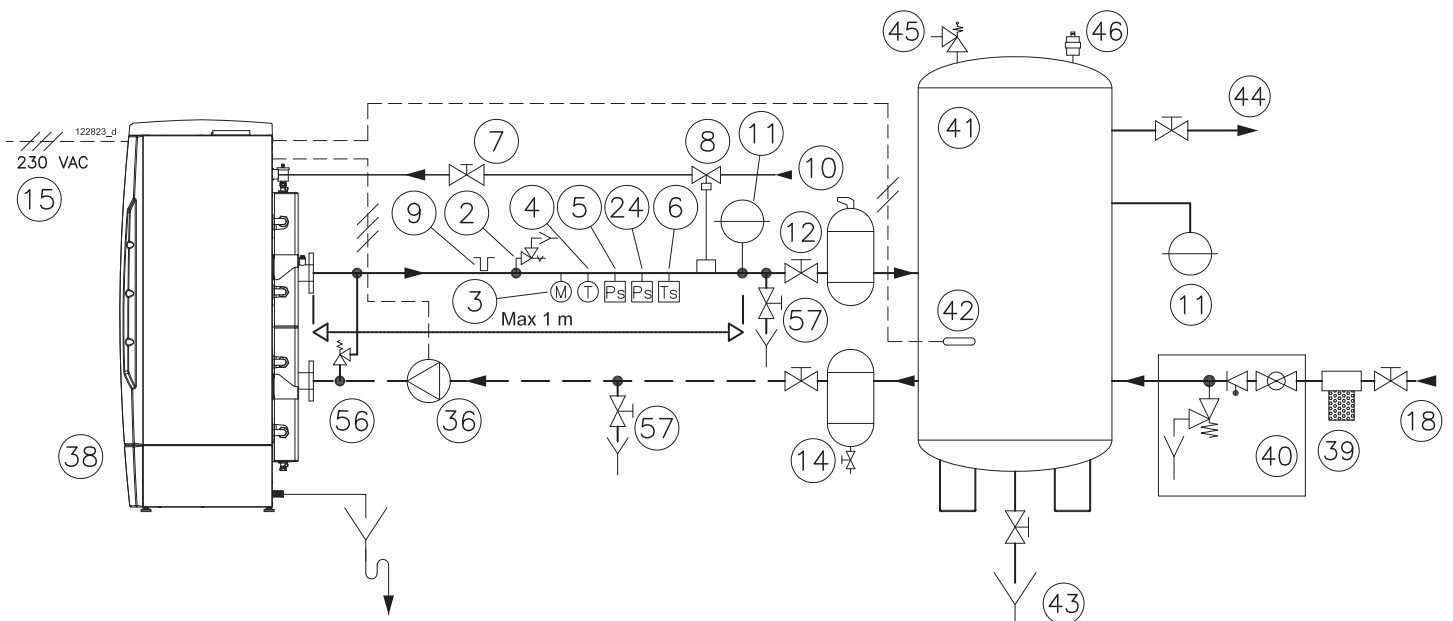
Exemple du schéma de raccordement chauffe-eau
